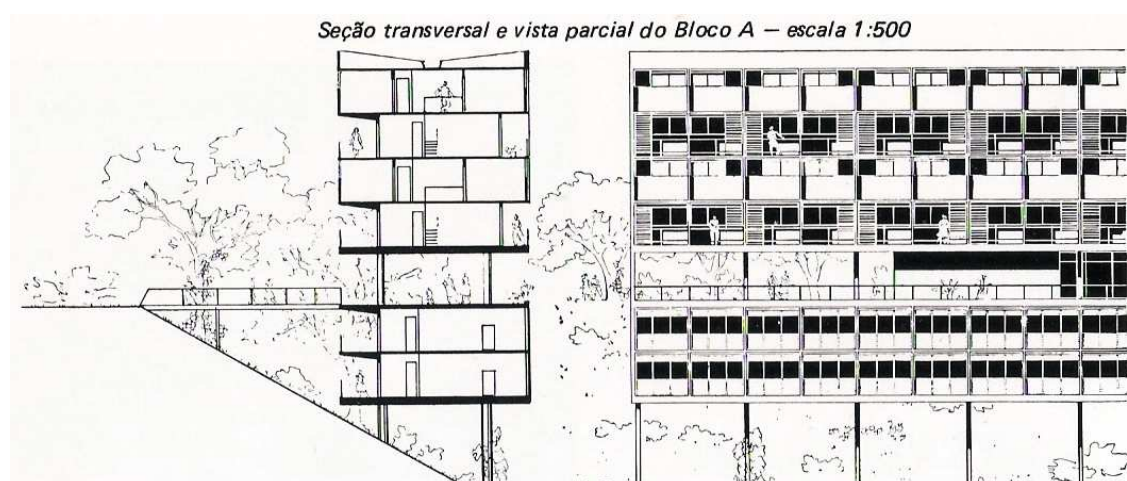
CORTE E ELEVACÃO DO BLOCO A
